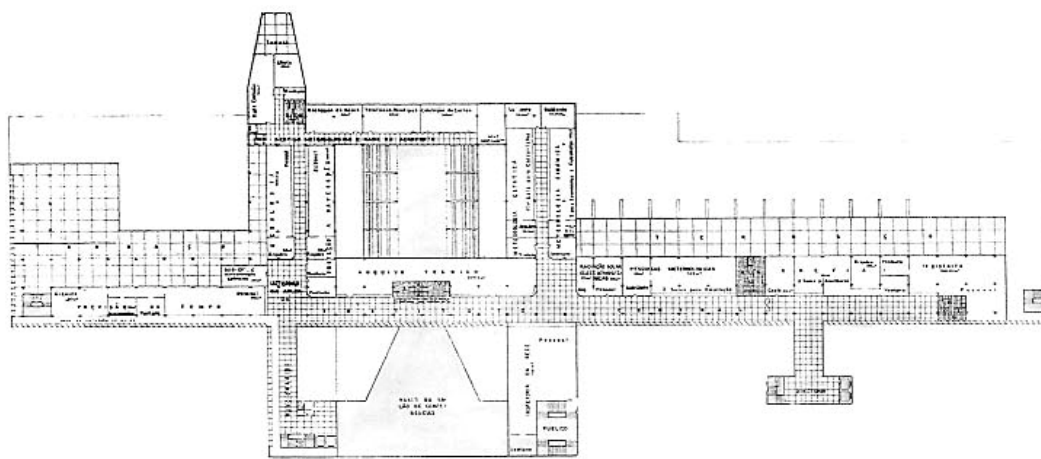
Anteprojeto de Marcel e Milton Roberto - planta baixa do 3º pavimento.
